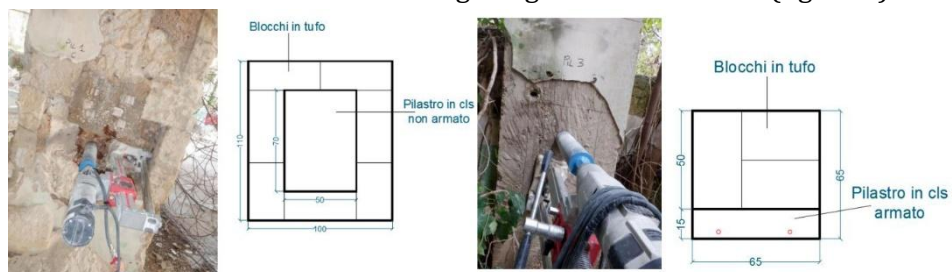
Sección transversal de los distintos pilares. (Elaboración propia).
